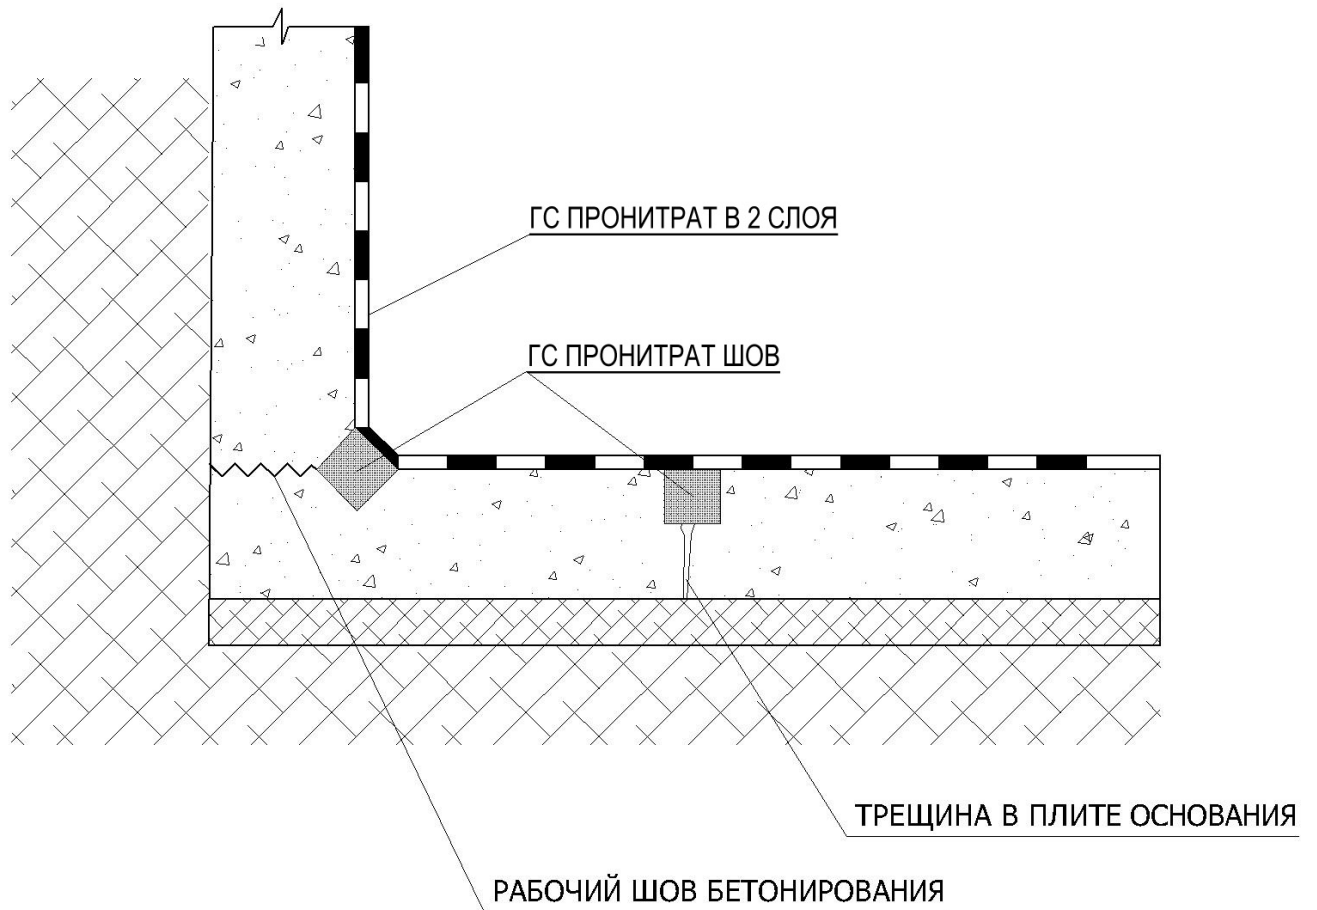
Устройство гидроизоляции монолитного бетонного пола
